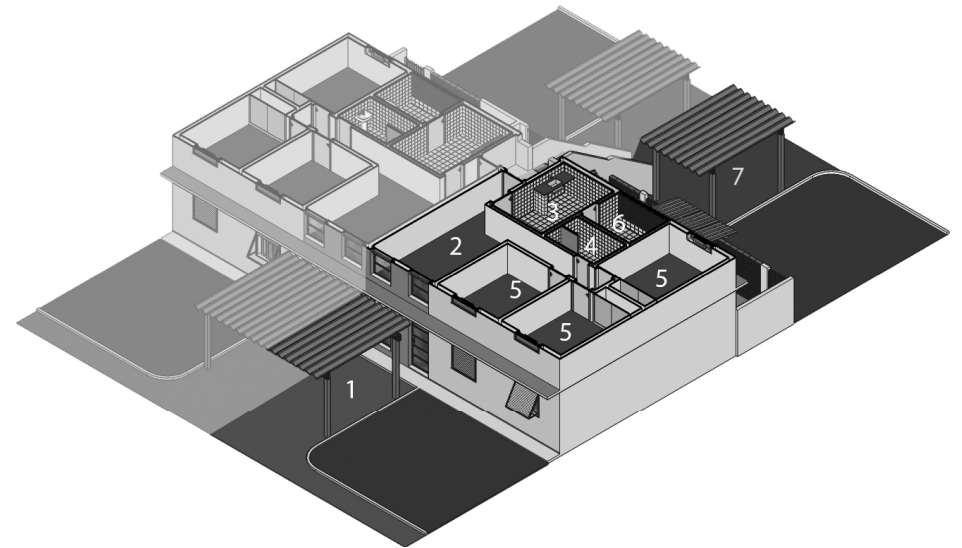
Unidade do Pavimento térreo. 1) Garagem 1pav, 2) Sala, 3) Cozinha, 4) Banheiro, 5) Dormitórios, 6) Área de Serviço, 7) Garagem Pav. Sup., 8) Quintal, 9) Dispensa. Fonte: Autor, 2018.
